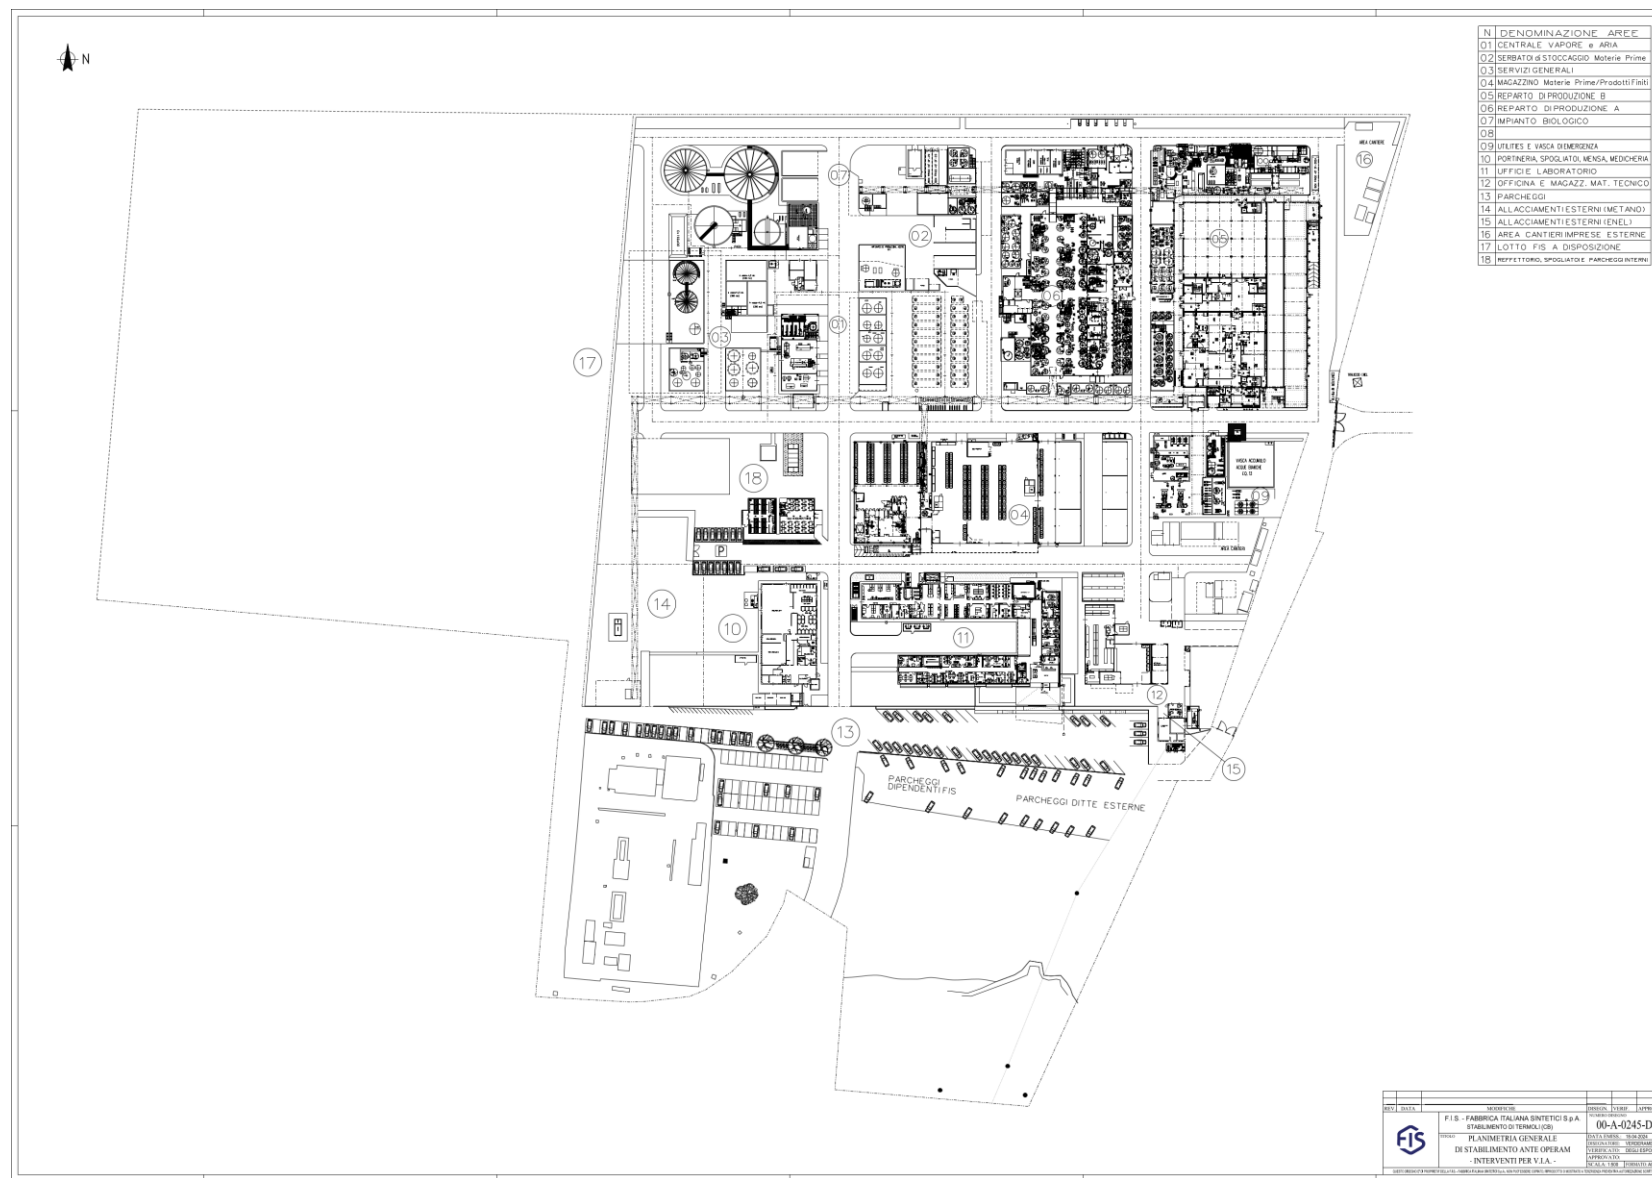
planimetria generale di stabilimento: assetto "ante operam"
